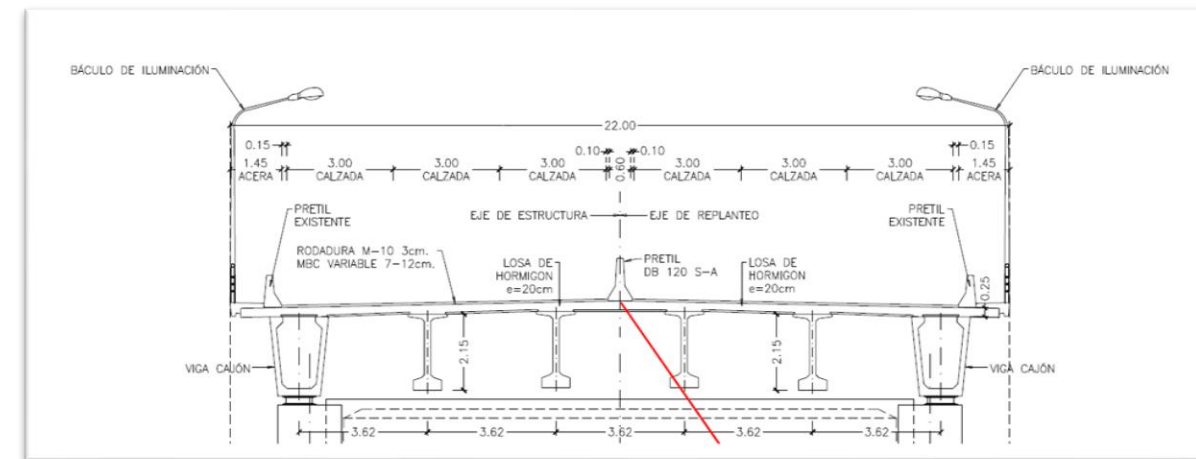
Imagen de la sección tipo proyectada generada sobre la pila 8
